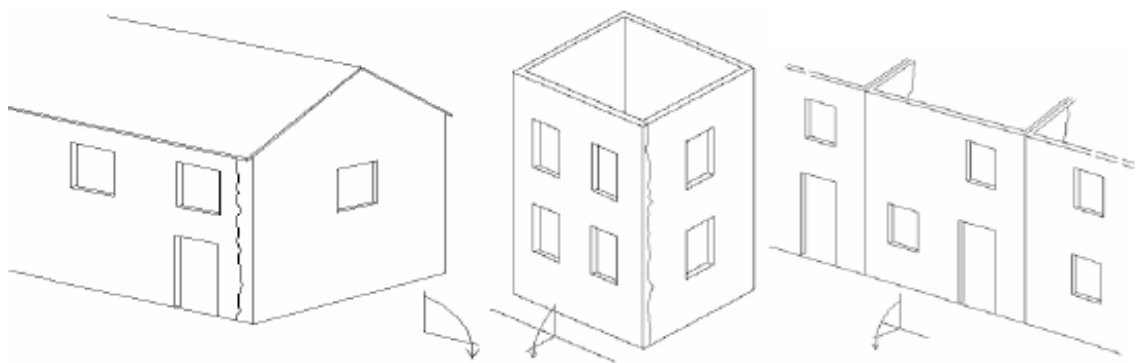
Fissuration et ruine des murs de contreventement sollicités perpendiculairement à leur plan [2]
